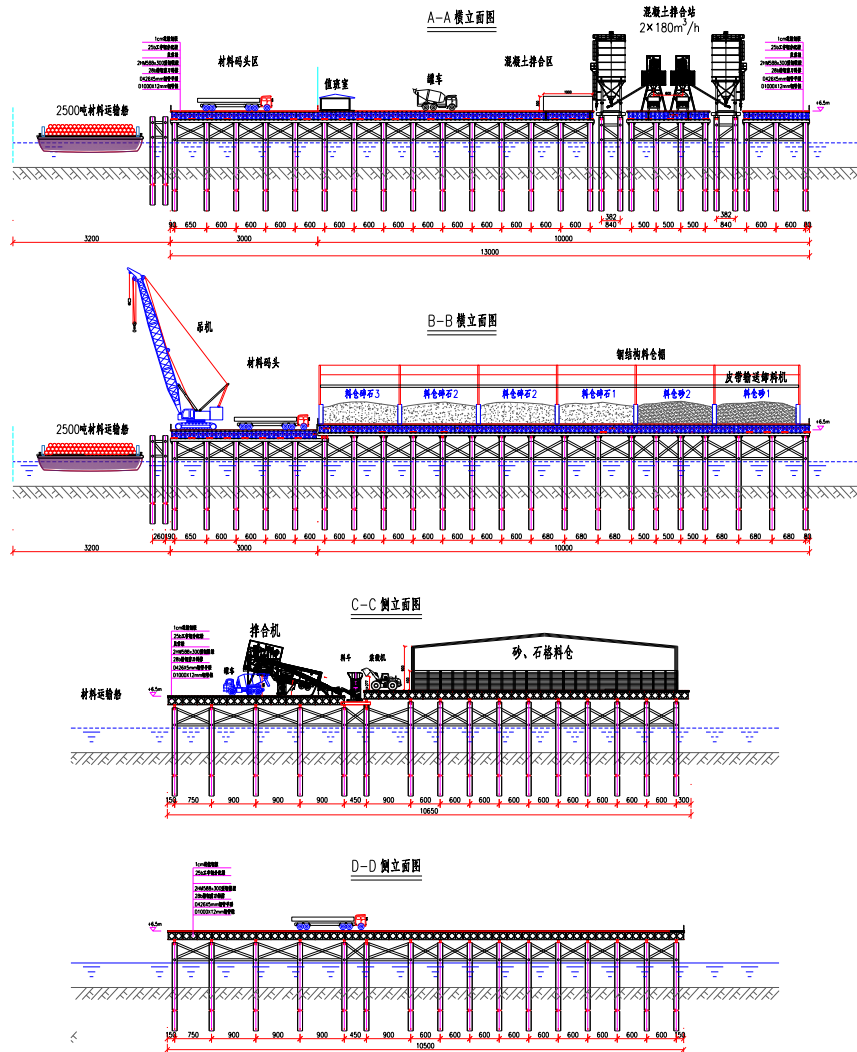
水上拌和平台、材料码头立面图（尺寸单位：cm）
